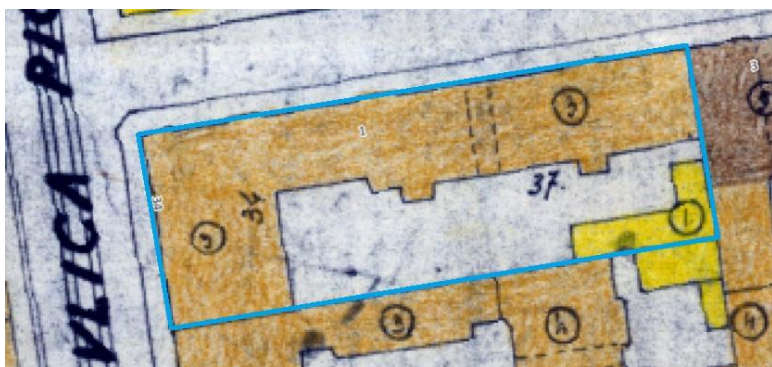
Dokumentacja archiwalna planu zabudowy posesji przy ul. Piotrkowskiej 20 z 1908 r. Widoczna studnia z pompą w północno-zachodnim narożu dziedzica. Źródło: Archiwa Towarzystwa Kredytowego w Łodzi, dostęp październik 2024, opracowanie własne.
